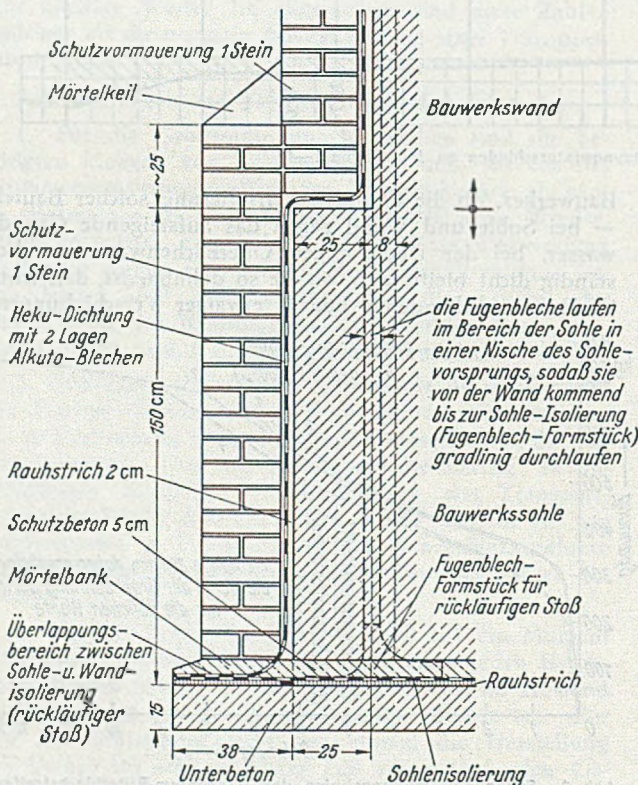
Isolierung und Schutzvormauerung am Übergang Sohle-Wand.
